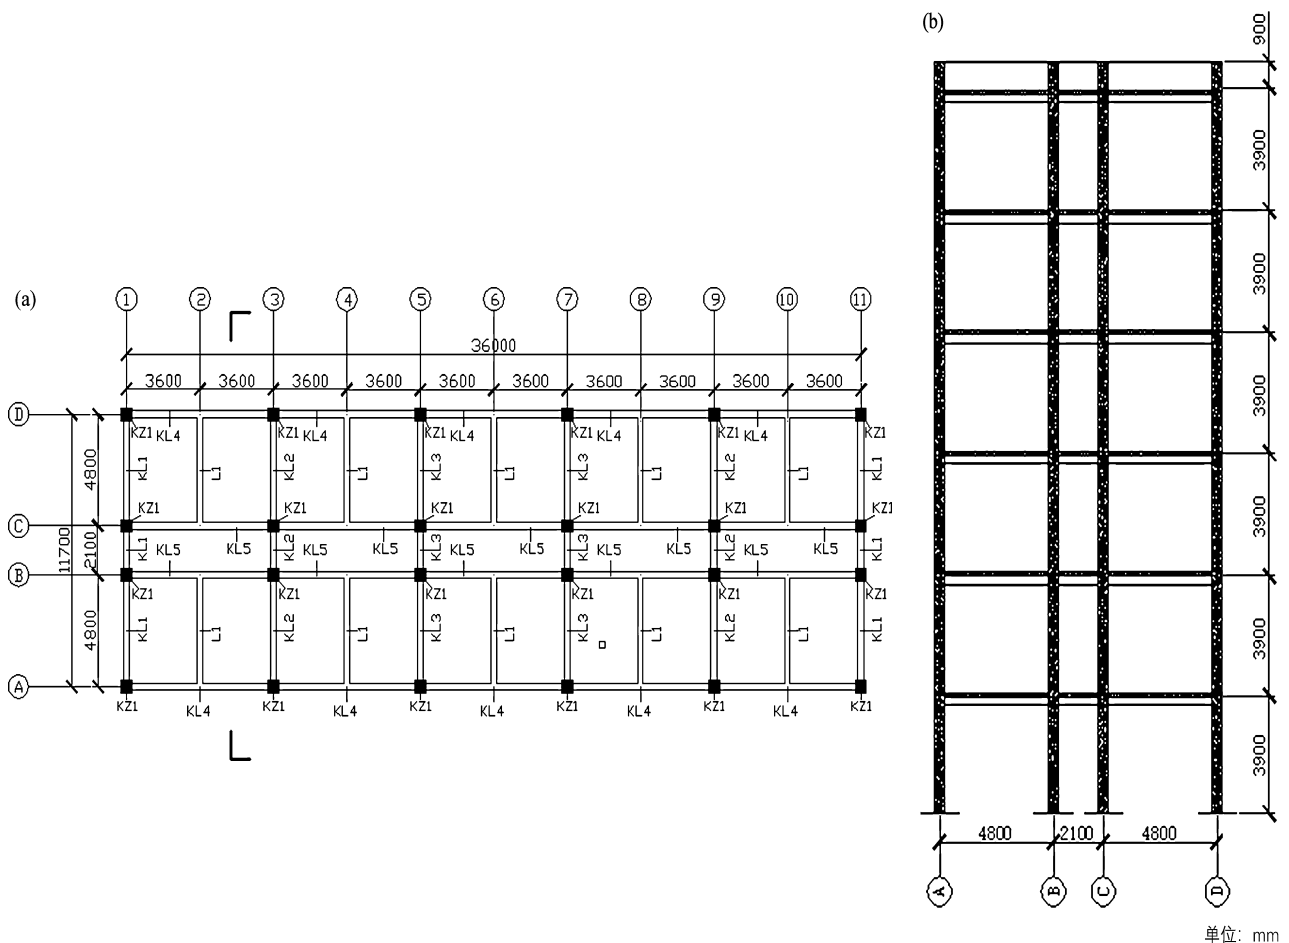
结构一层平面图 (a) 及结构剖面图 (b)
